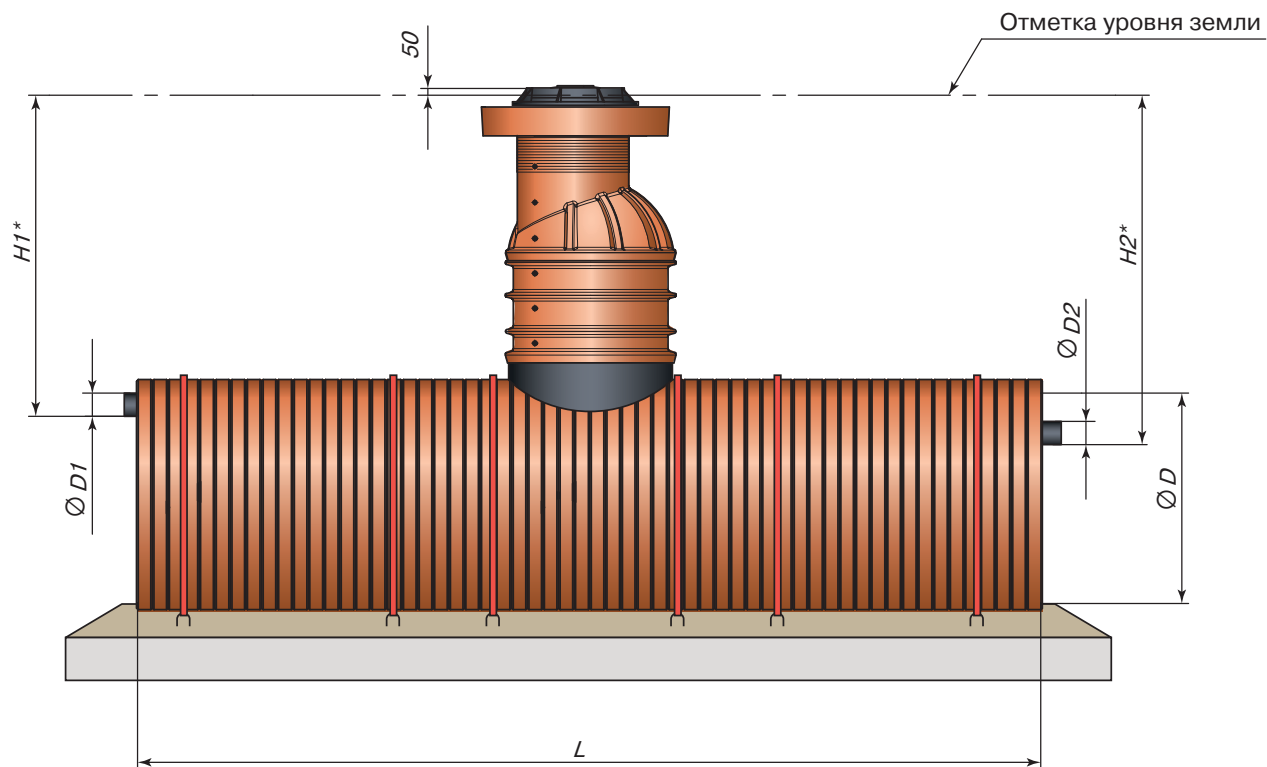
Габаритные параметры резервуаров ИКАПЛАСТ
